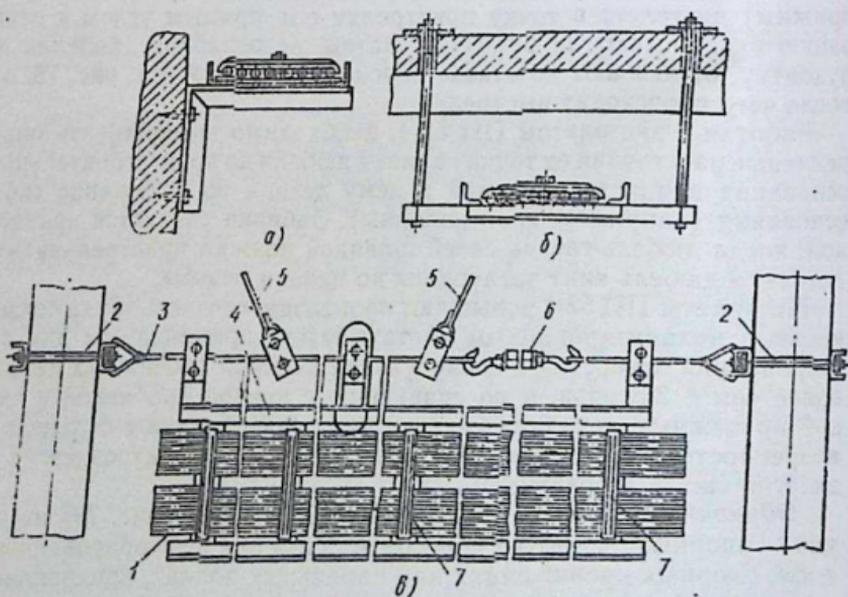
Прокладка групповых трубных проводов на кронштейнах, прикрепляемых к стене дюбелями (а), подвесках, закрепляемых к потолку (б), и тросах, закрепляемых между колоннами здания (в):
